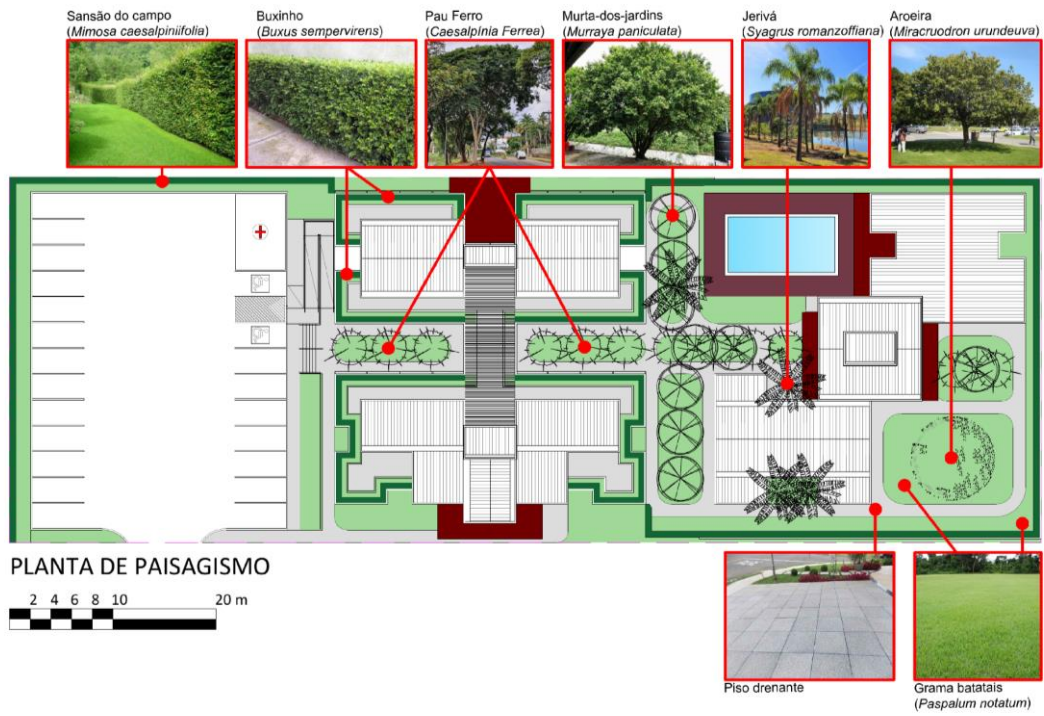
PLANTA DE PAISAGISMO. FONTE: AUTORAL.
